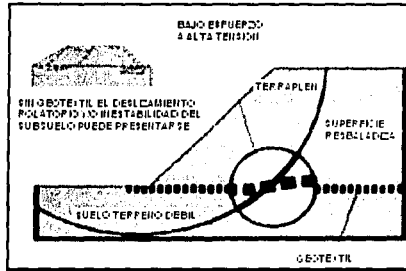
Incremento de la capacidad cortante en terraplén con refuerzo de geotextil
